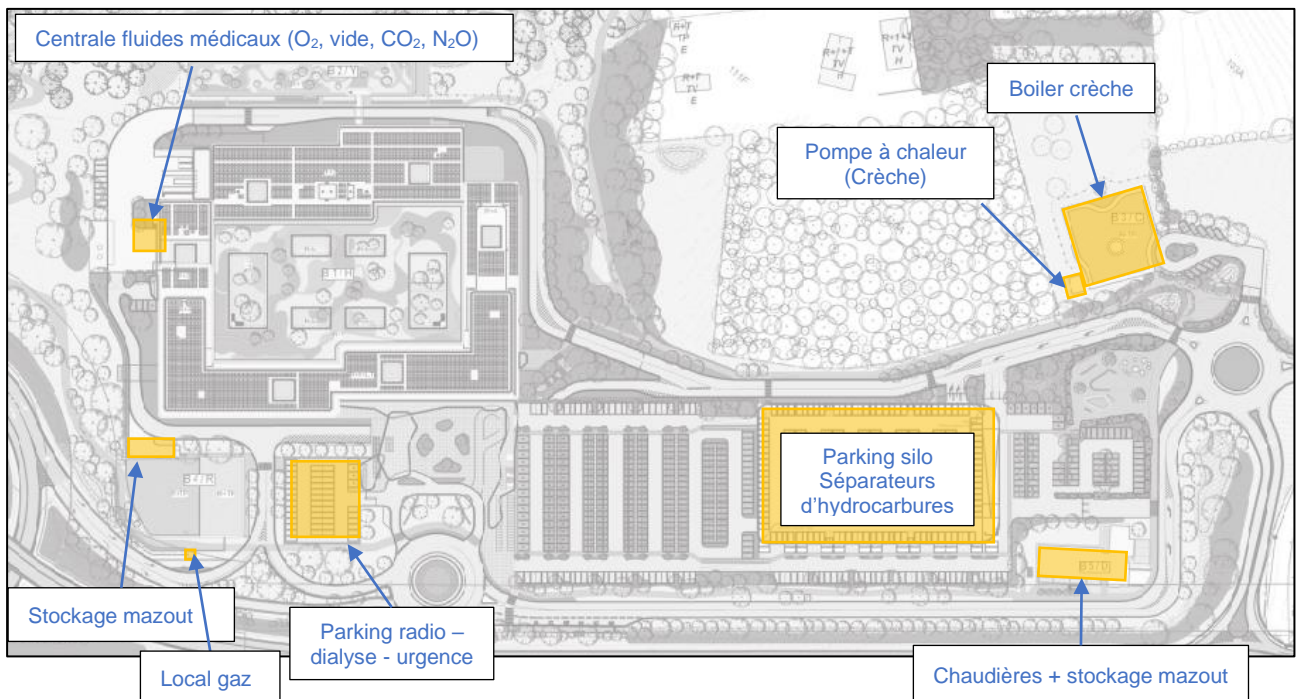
Positionnement des installations (en extérieur ou enterrées)
